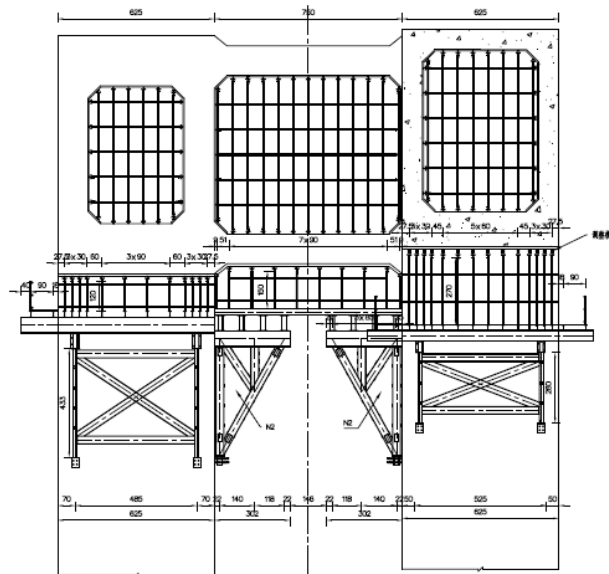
横桥向下弦 0# 块及系梁施工立面示意图 (单位: cm)
